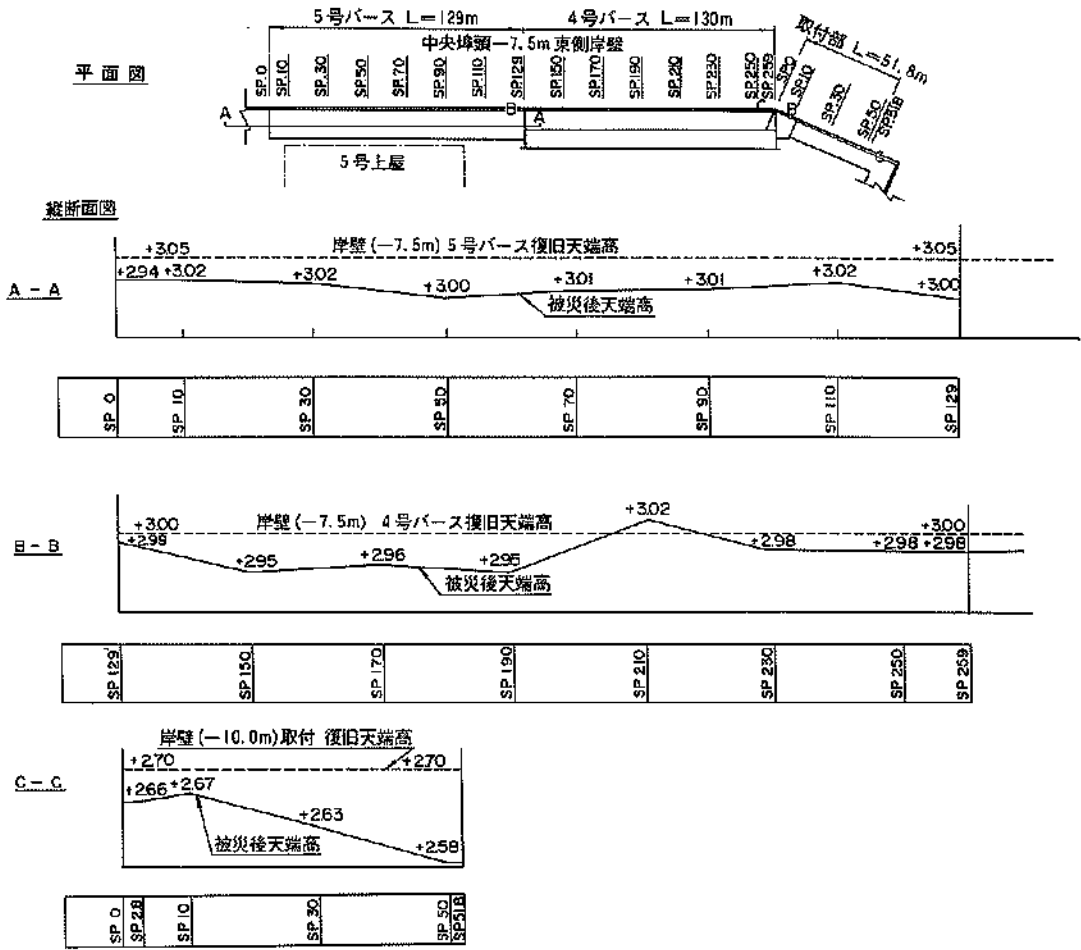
エプロン沈下断面図 (中央埠頭地区, ④岸壁 (-7.5m))
